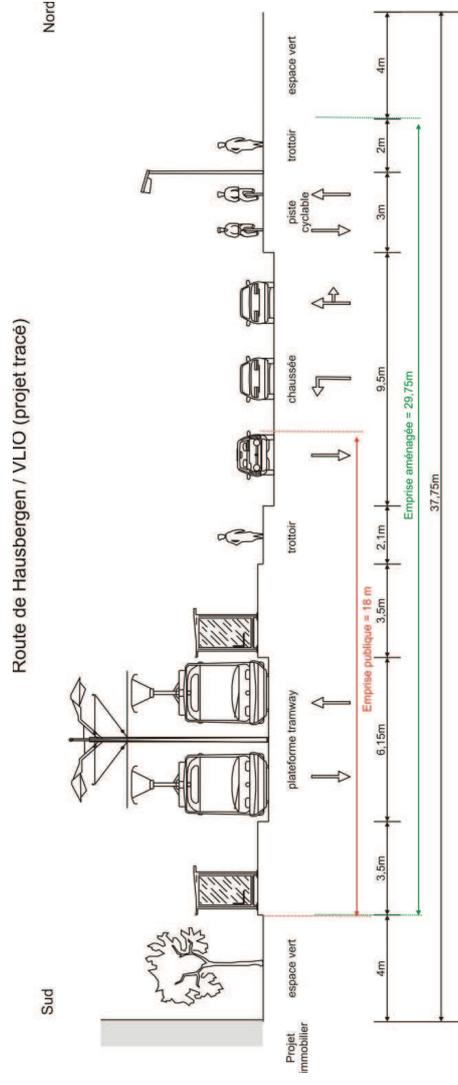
Situation projetée (coupe 13bis) sur la route de Hausbergen en station, au droit de la rue de la Haye
